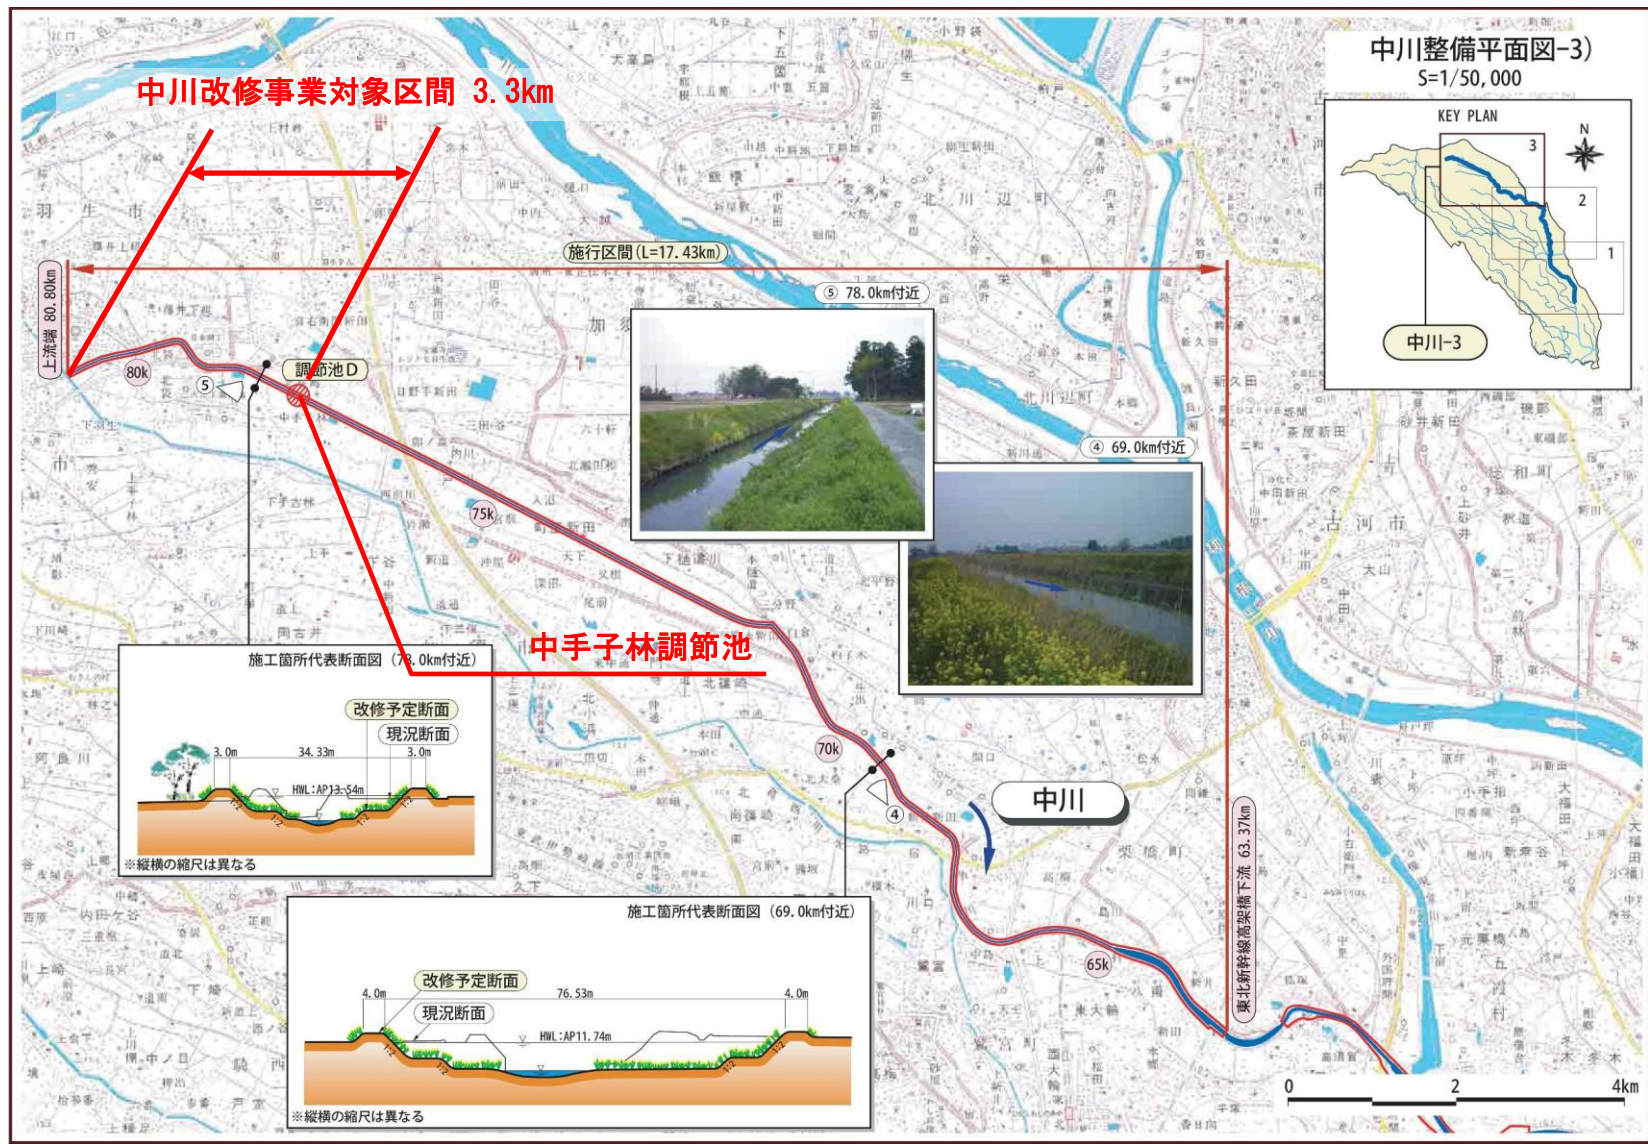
7 一級河川中川整備計画(埼玉県管理区間最上流部) 平面図
